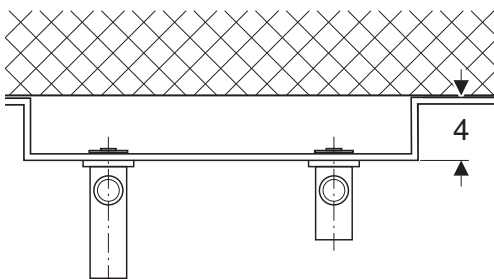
Dimensiones para montaje visto con placa de fijación Geberit escalonada
